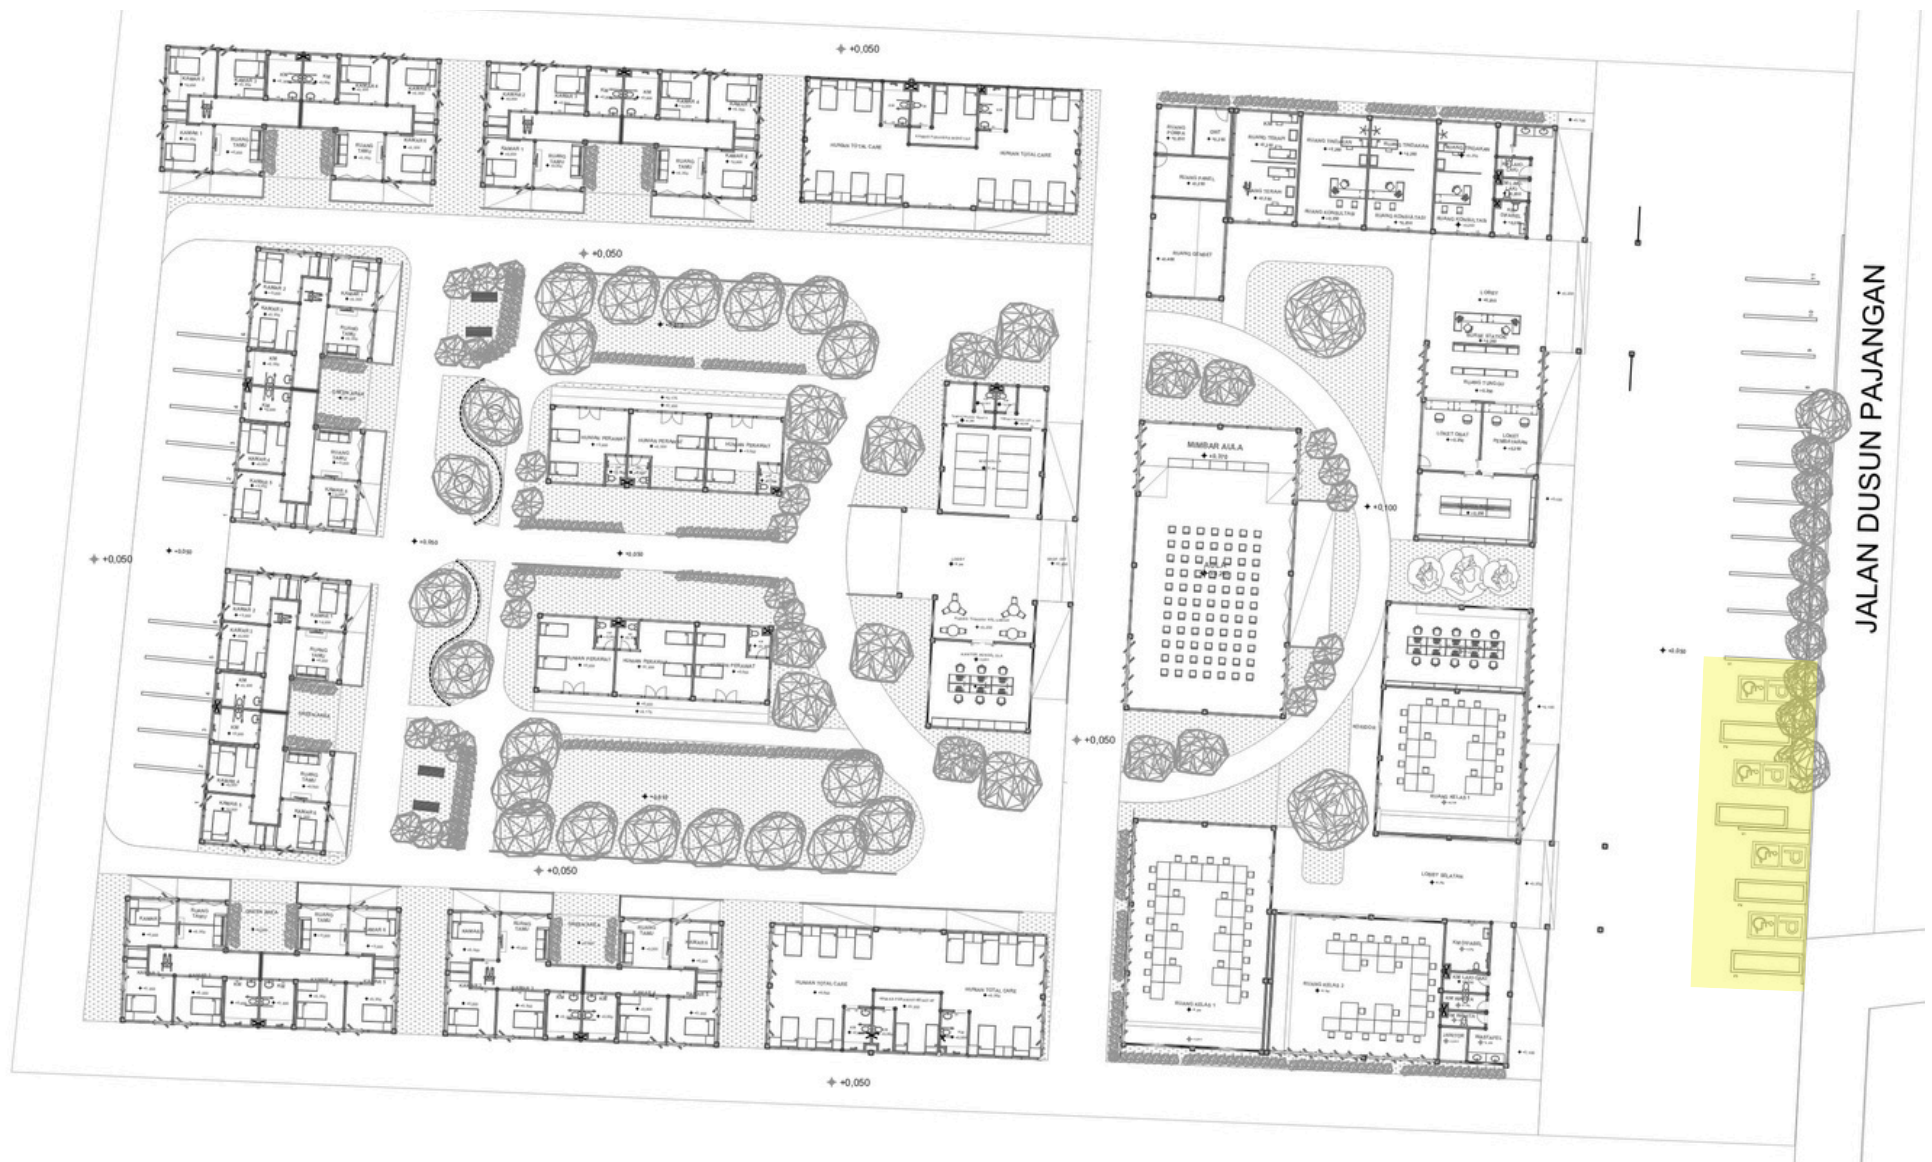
Rancangan Peletakan Ramp dan Railing
